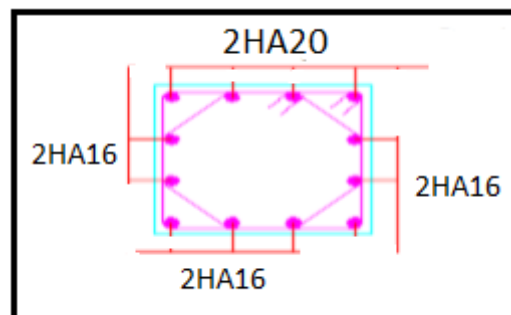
Schéma de ferrailage du poteau (section transversale).
